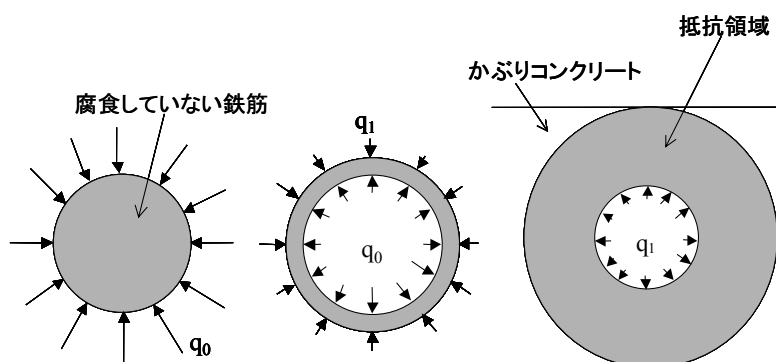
腐食膨張によるひび割れ発生の力学モデル
